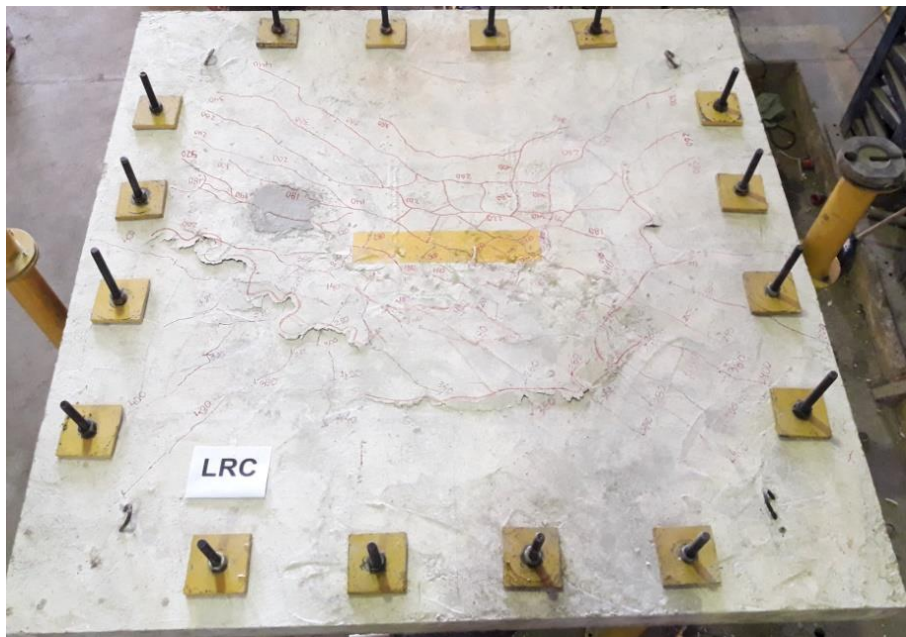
Padrão de fissuração da laje LRC
